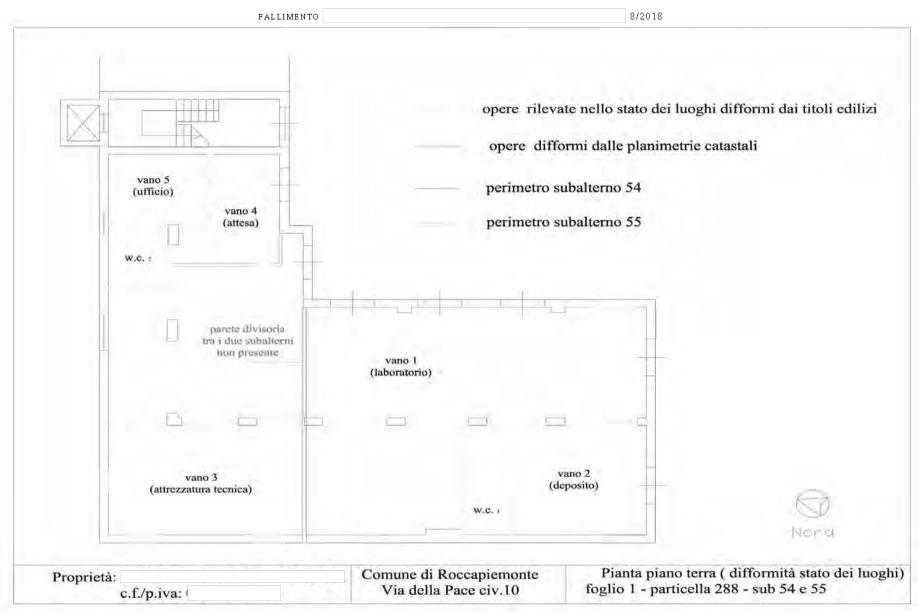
º - rappresentazione planimetrica difformità stato dei luoghi locali commerciali fgl 1 p.lla 488 sub 54 e sub 55
